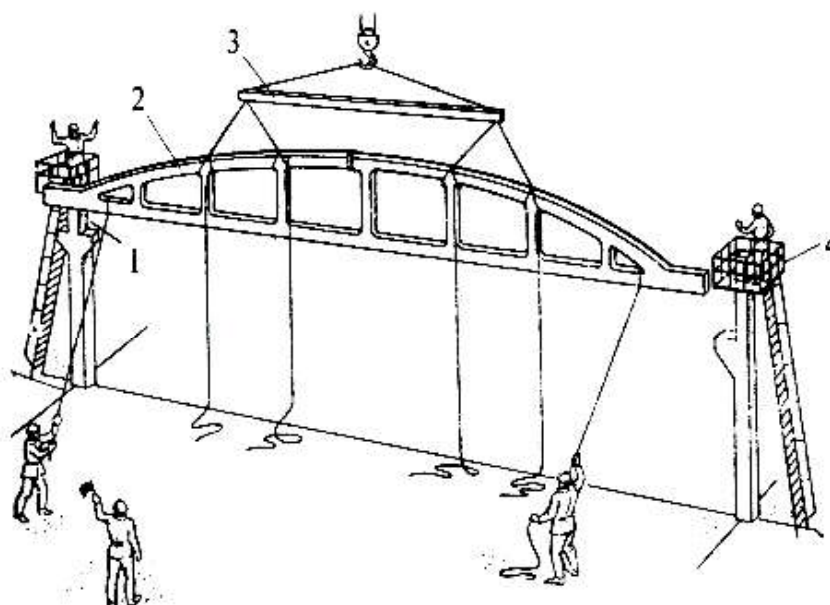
Установка и закрепление фермы на опорах колонны:
